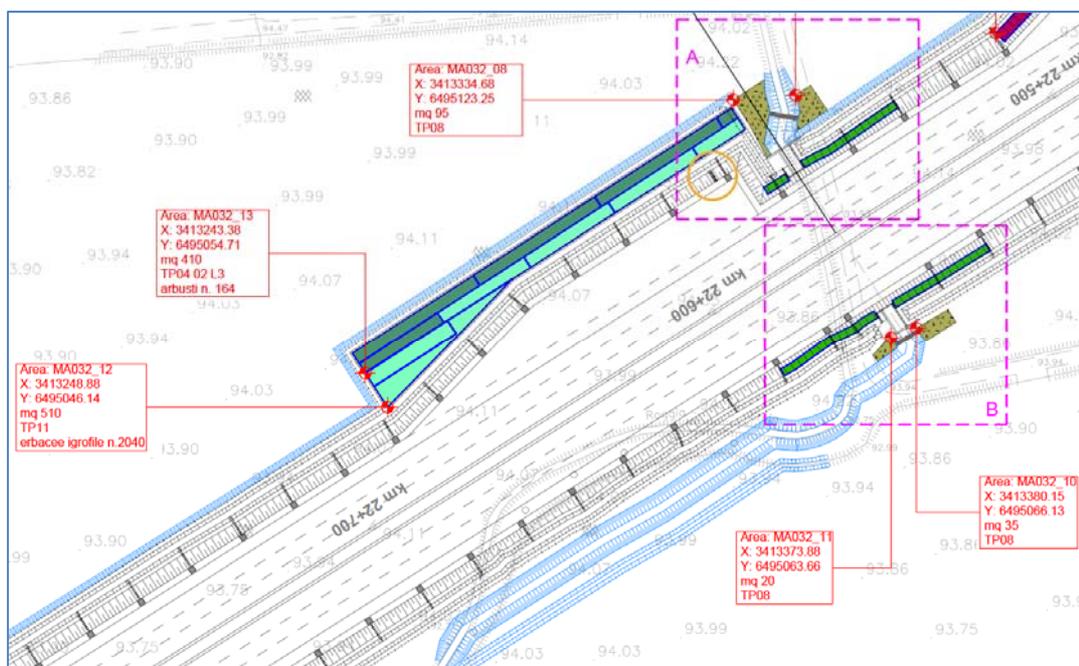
Stralcio planimetrico della landa ecologica disposta lungo l'asse TEEM
